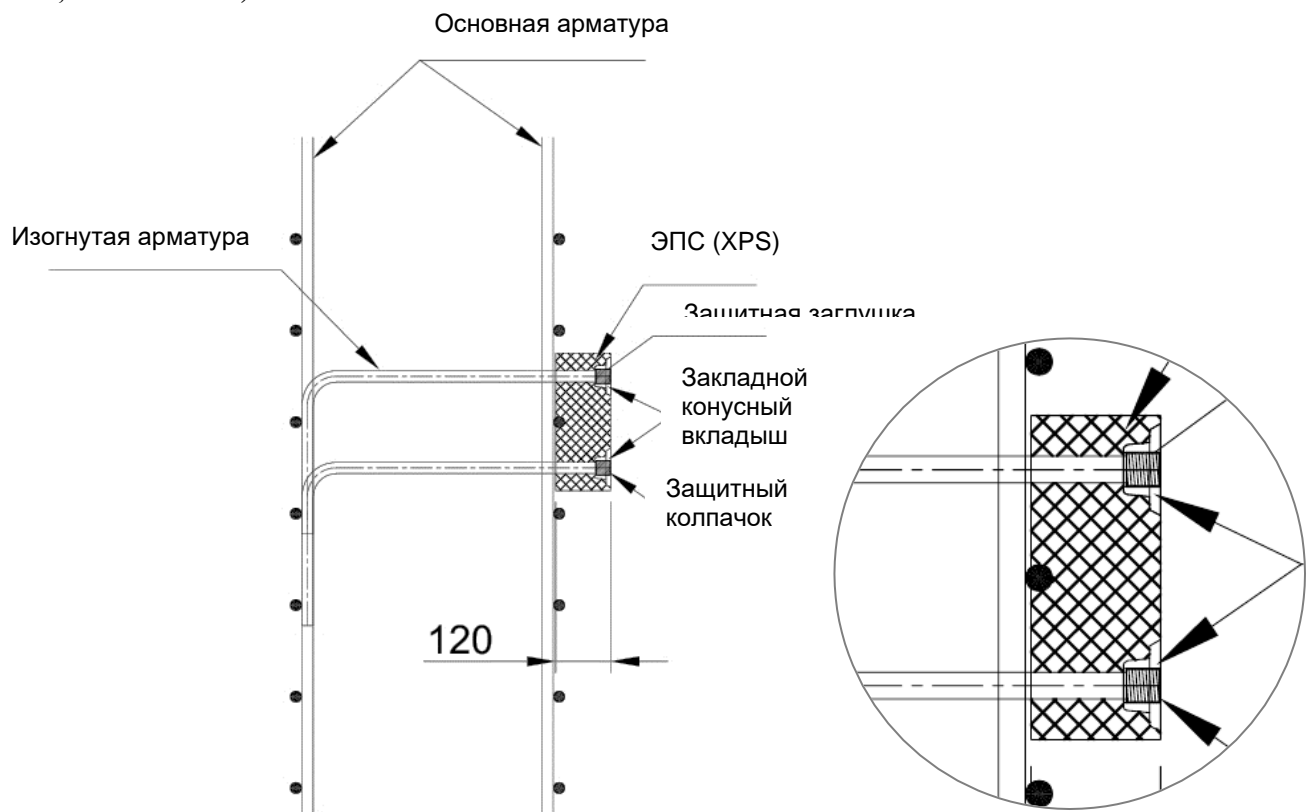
Установка соединительных муфт с защитными заглушками и закладными конусными вкладышами и плиты XPS
